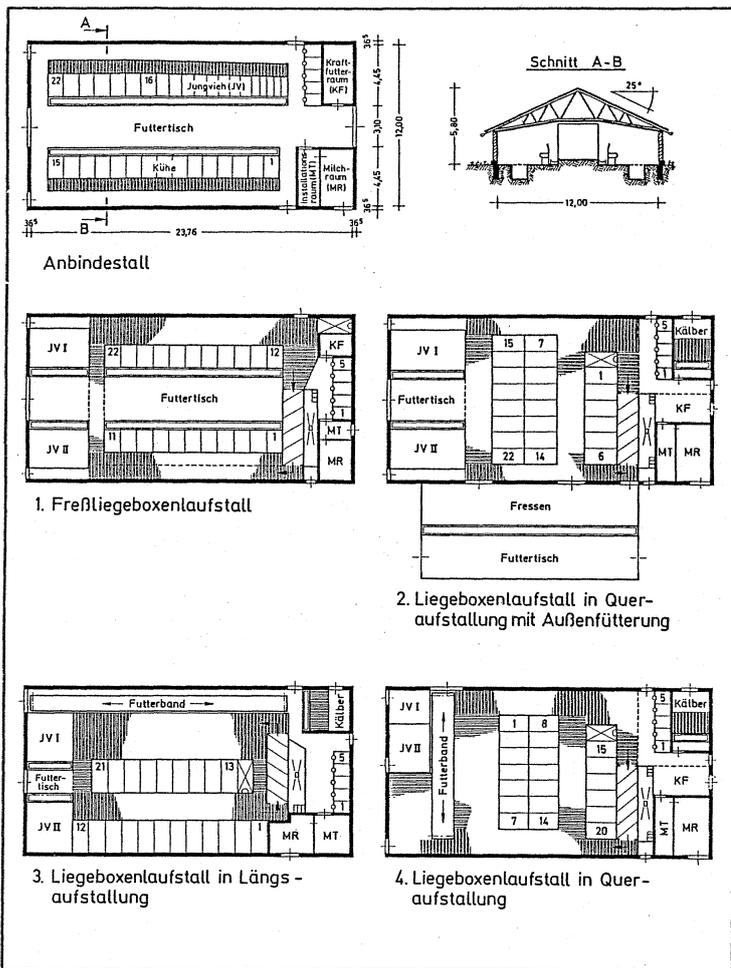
Umbaulösungen für einen bestehenden Anbindestall mit 20 Kühen und Nachzucht
